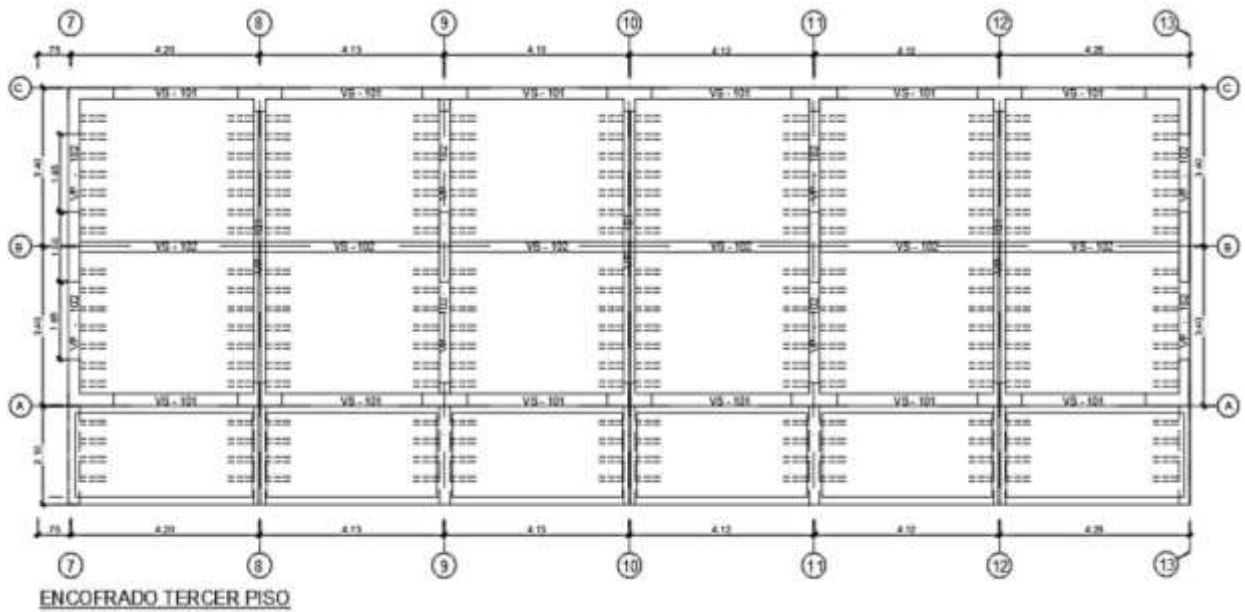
Plano de encofrados para módulo escolar de 3 pisos.
